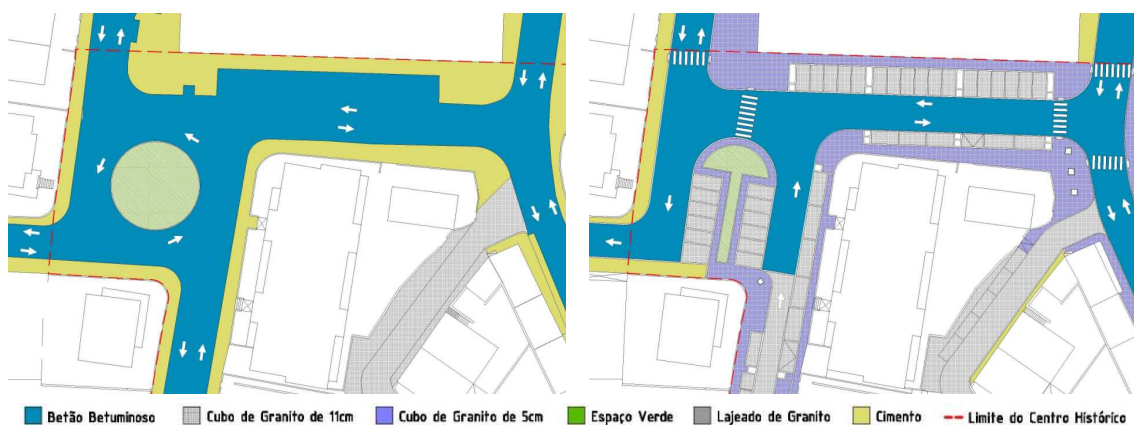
e 12 – À esquerda, planta da Praça D. Dinis, em 2000; à direita, planta da Praça D. Dinis, em 2008.
